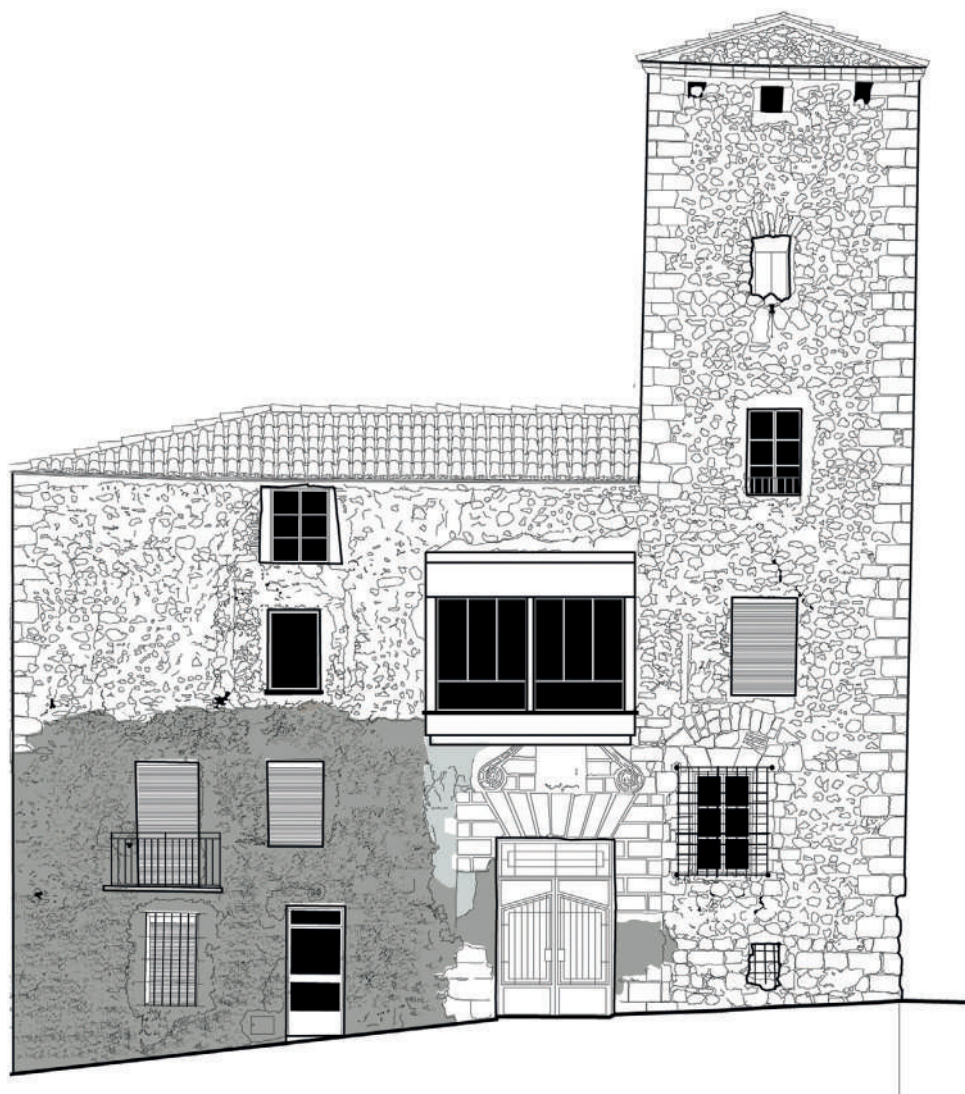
Modelo vectorizado de la fachada principal o sureste.
